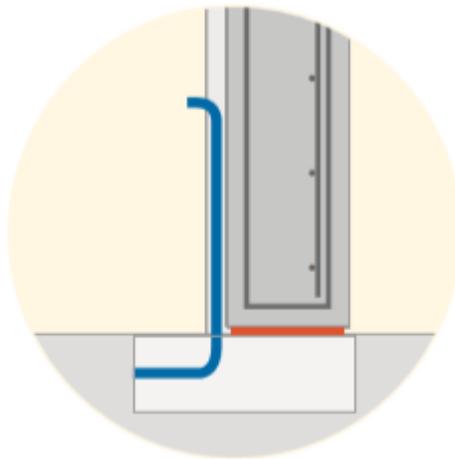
Instalación Sanitaria Fuente: Baumax
